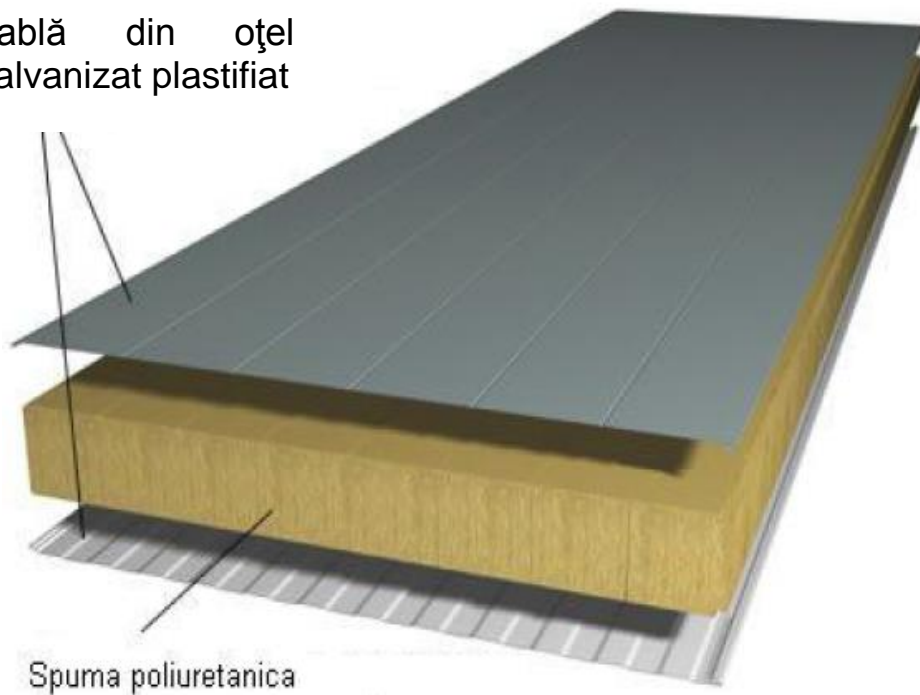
Fig.15. Construcția panourilor de tip sandwich
